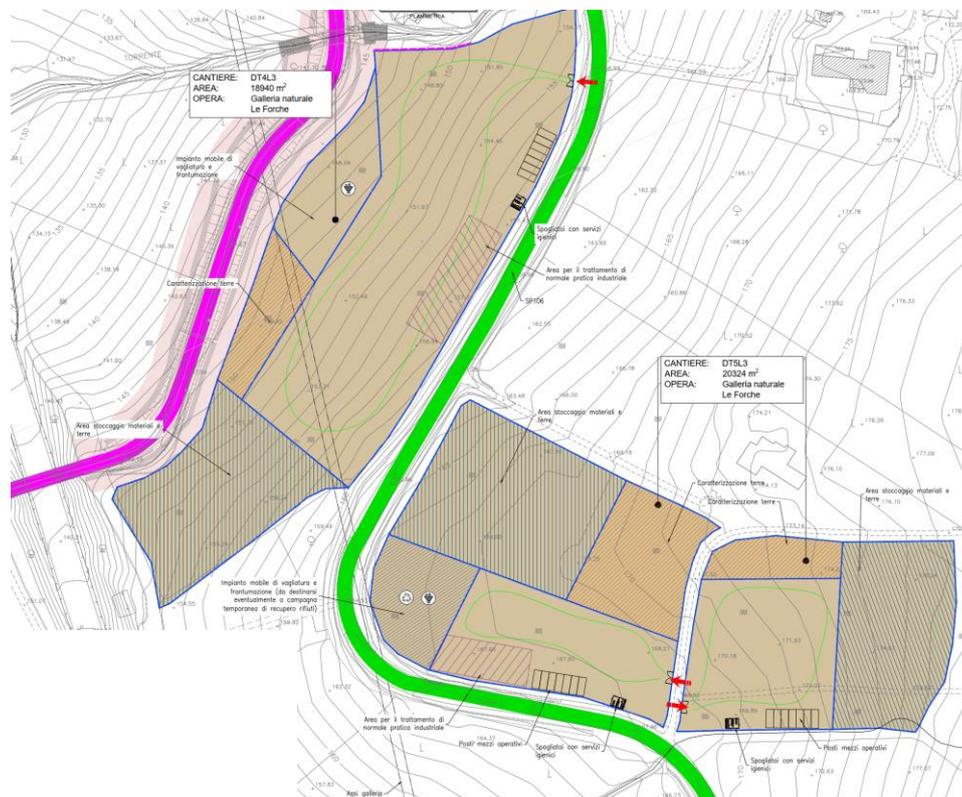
Planimetria di dettaglio DT4L3 e DT5L3
